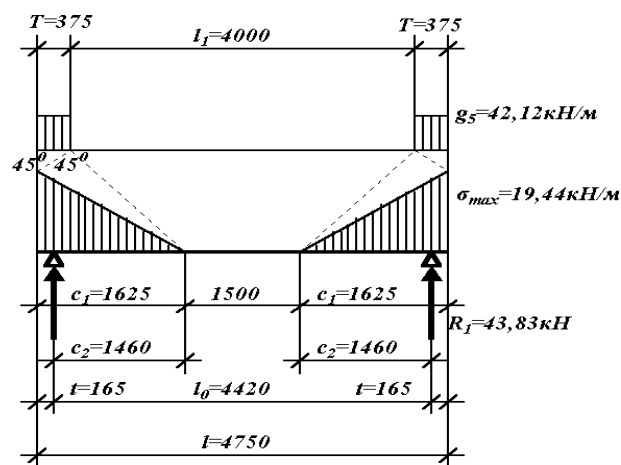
Розрахункова схема фундаментної балки для другого випадку завантаження
